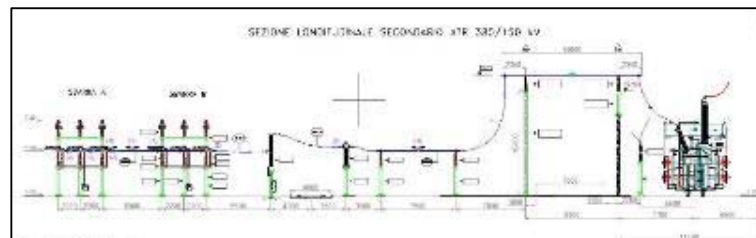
Lay out della Stazione di Ponte Galeria e sezioni longitudinali ATR 380/150 kV
